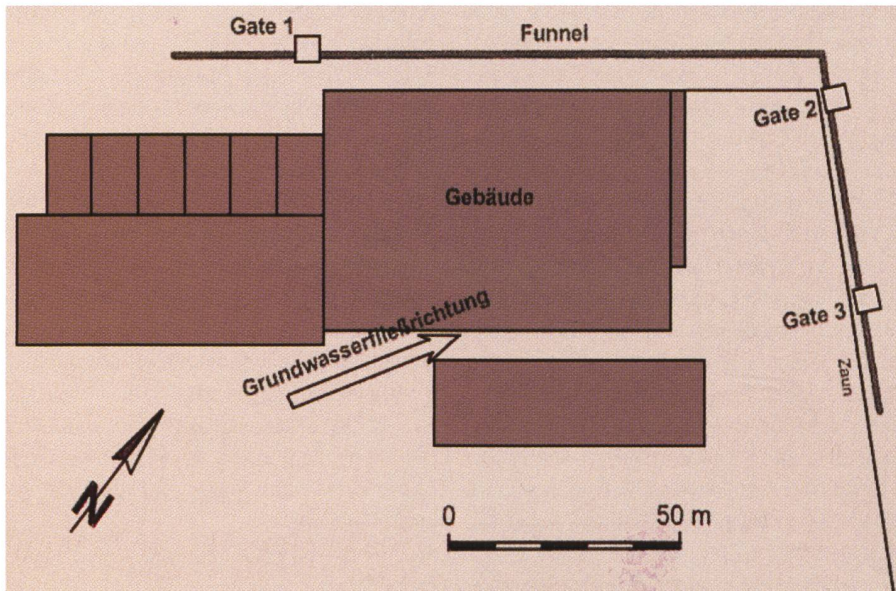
In-situ-Grundwasserreinigung nach dem Funnel-and-Gate-System in Tübingen (Lageplan).
